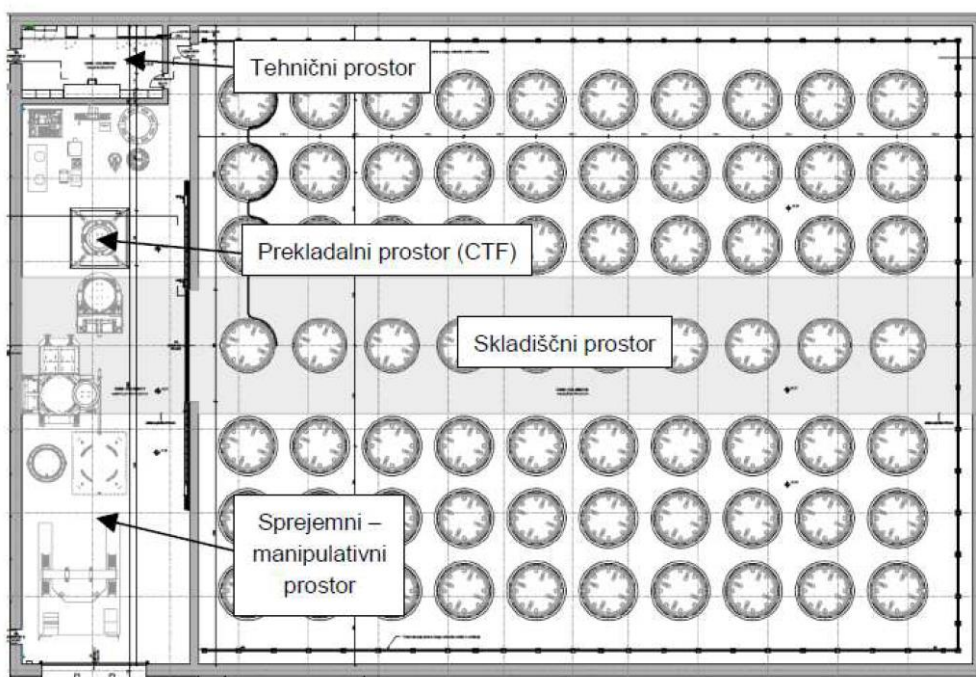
Grundriss des Trockenlagergebäudes für ABE
